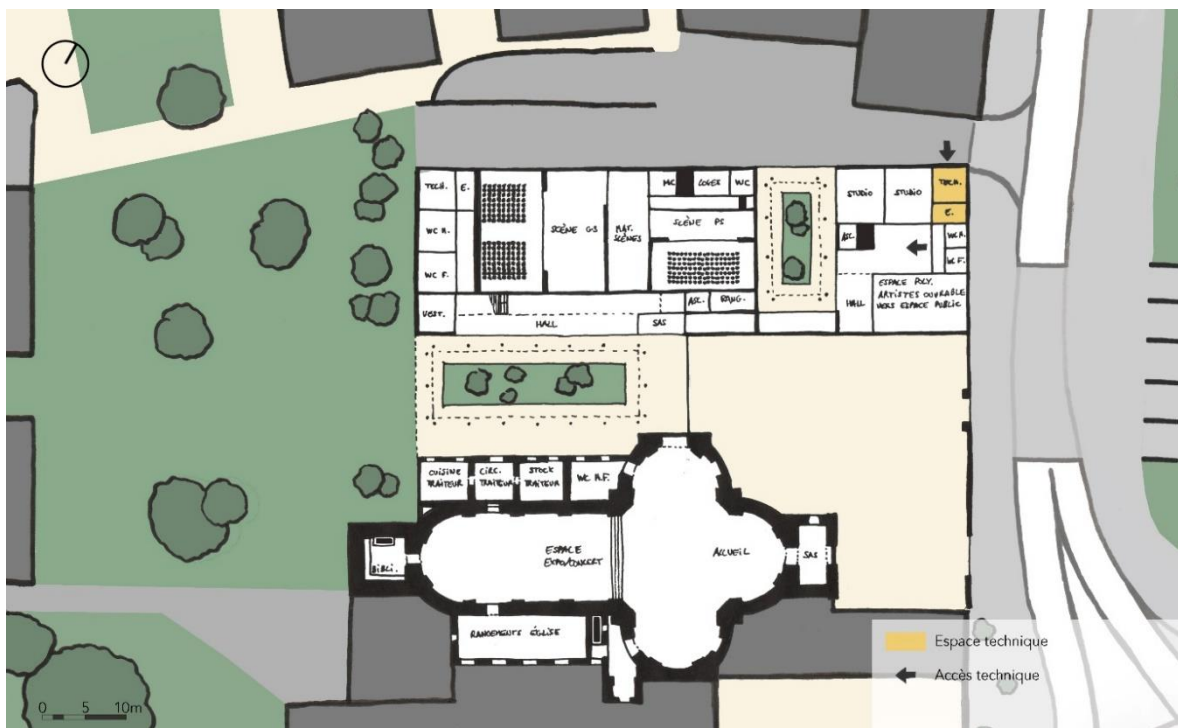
Distribution des locaux et accès techniques du bloc Conservatoire (fond de plan WalOnMap, 2016)
